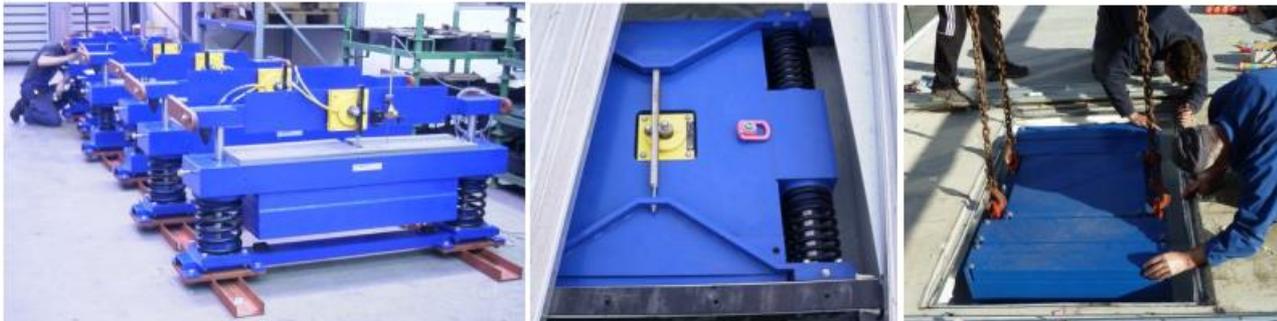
standardTMD* und *controlledTMD* in vertikaler und horizontaler Ausführung und präziser Einbau im Bauwerk
